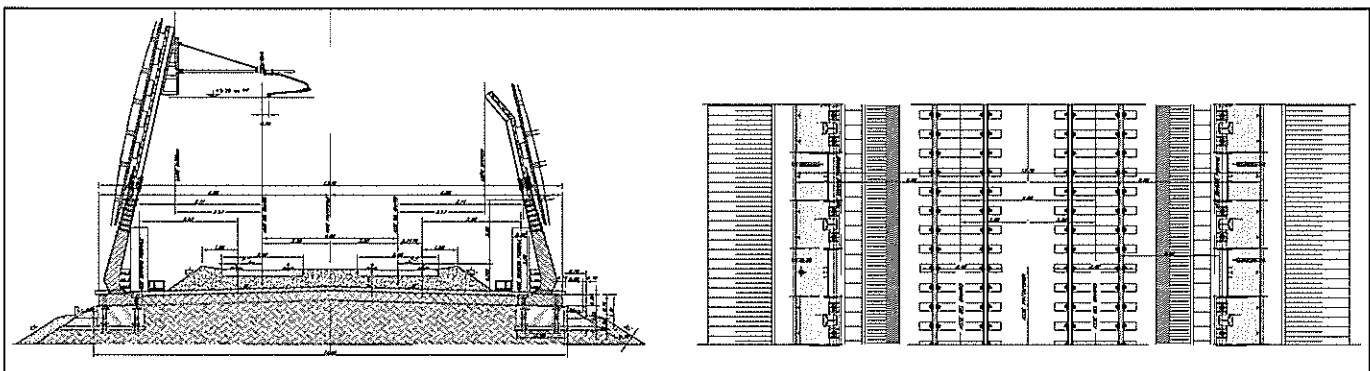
Sezione Tipo doppio binario in Rilevato con Barriere Antirumore
